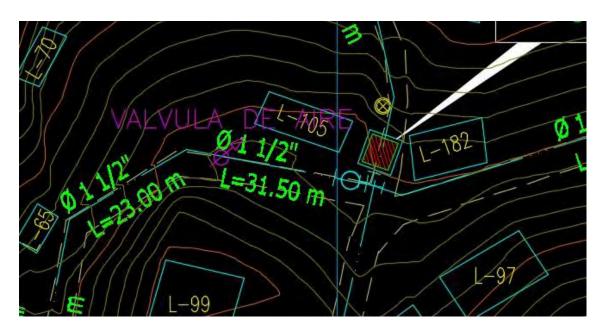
Ubicación válvula de aire. Fuente: Planos de Replanteo.
